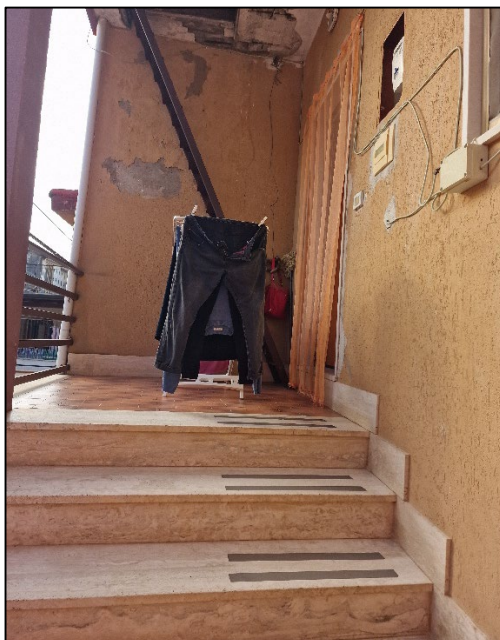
viste della scala esterna e dell'ingresso, che apre sul Piano Primo. Andrebbe opportunamente prevista una revisione del cornicione aggettante, all'attualità degradato.
